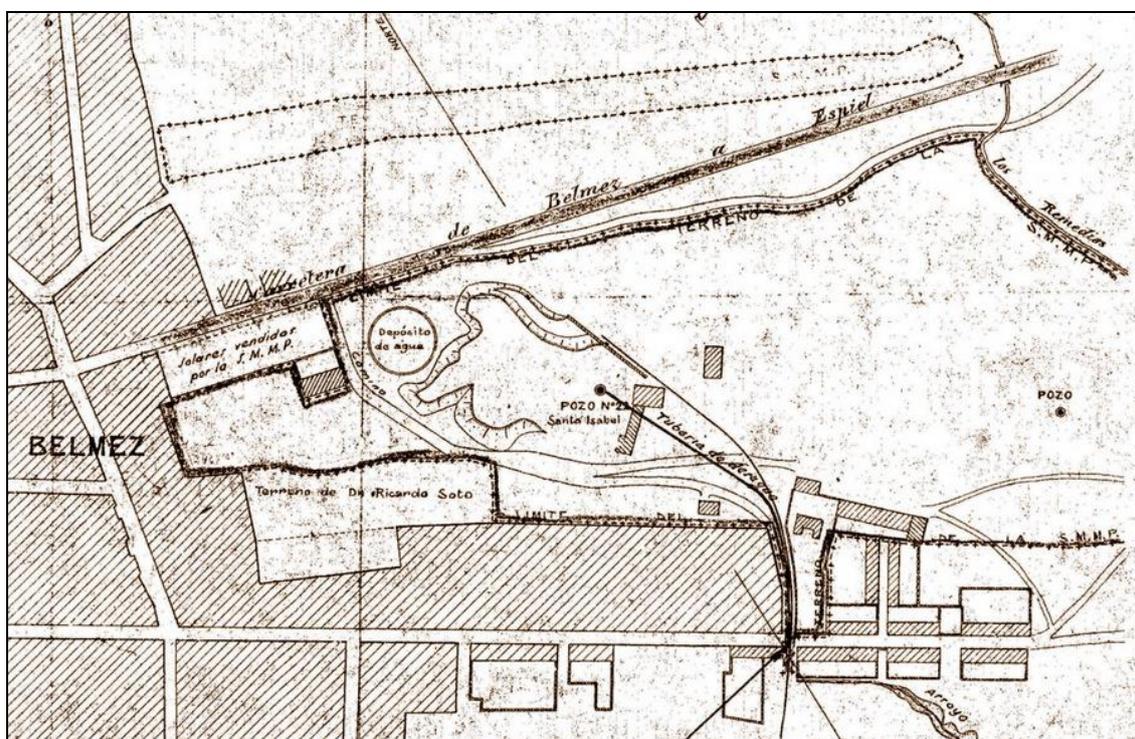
Plano de situación del pozo nº 22 (Arch. J.M. Sanchis)
